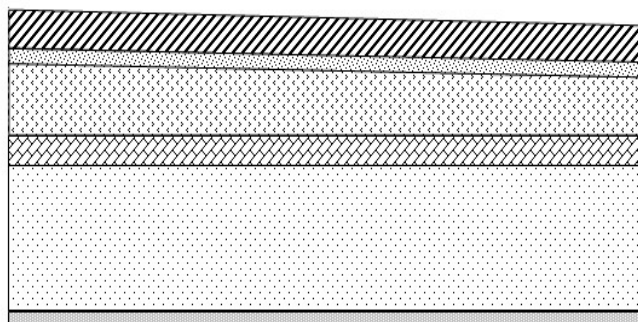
Coupe verticale du plancher terrasse à dalle pleine.
